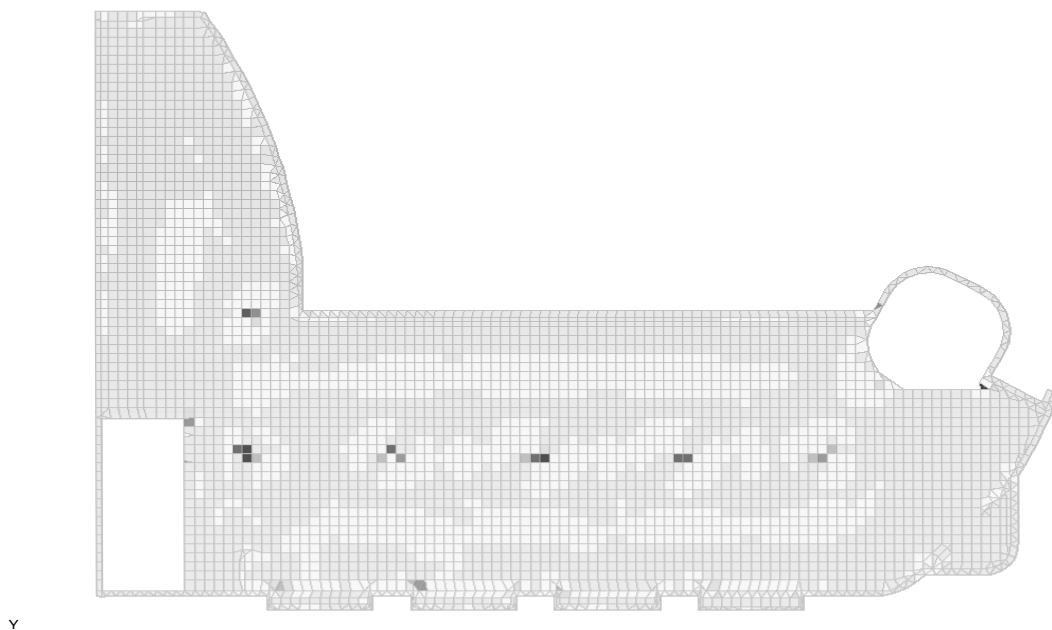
Клейонка армування верхньої арматури вздовж осі X для плити перекриття 1-го поверху
